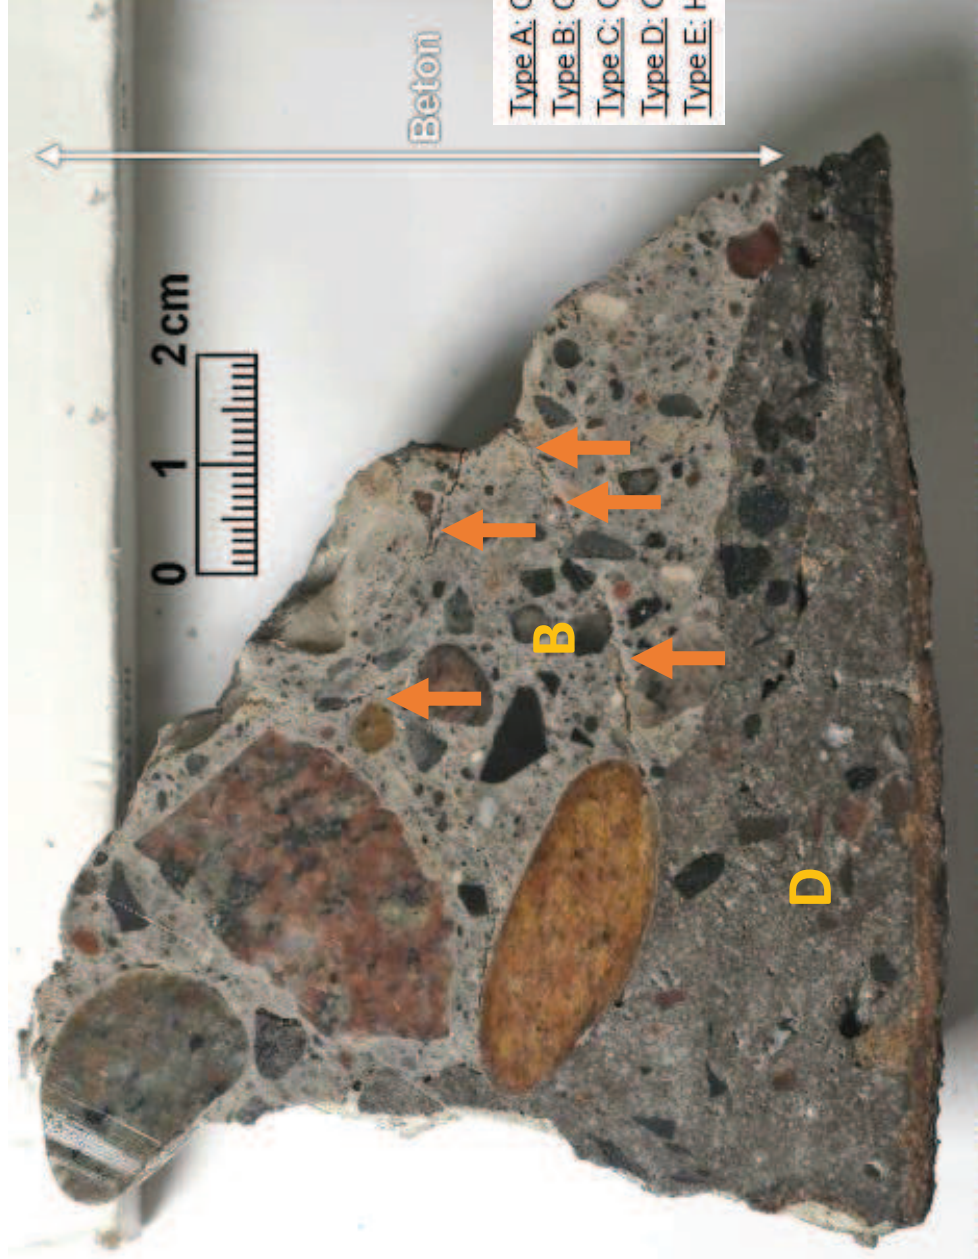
Betonstykke P36: På fotoet ses et tværsnit gennem betonstykket på foto 14 med altanens forkant nederst. I betonstykket kan to type reparationsmørtel udskilles. Op til betonen ses flere påføringer af en grå, grovkornet mørtel (type B) som fremstår håndudsat med store luftindeslutninger. Nederst ses et tyndt lag grå, finkornet mørtel (type D).
